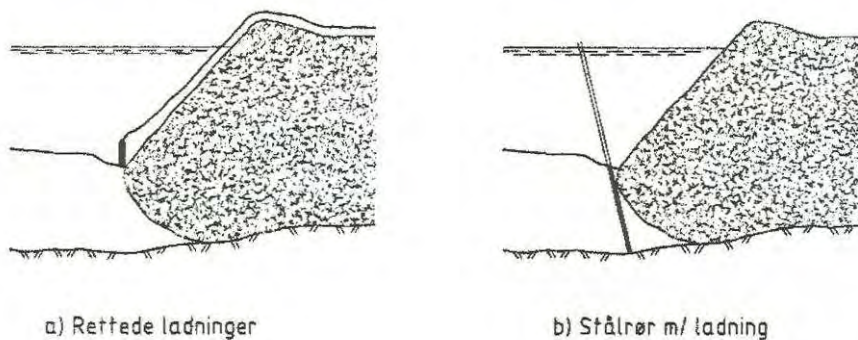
15 Utlegging av steinfylling med fortrenning av bløte masser
